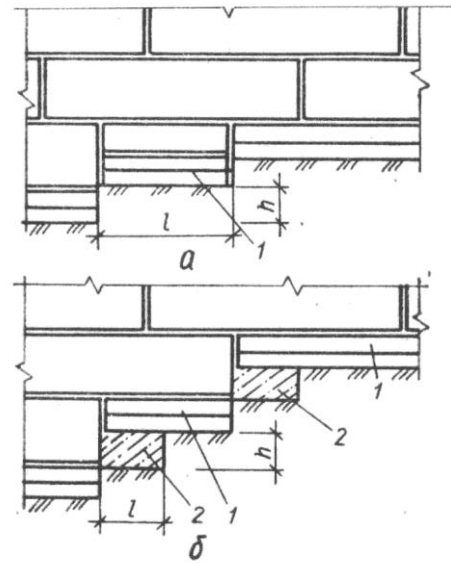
Перехід фундаменту від однієї відмітки закладення до іншої: а – збірних, б – з використанням монолітного бетону; 1 – фундаментні плити, 2 – бетон
